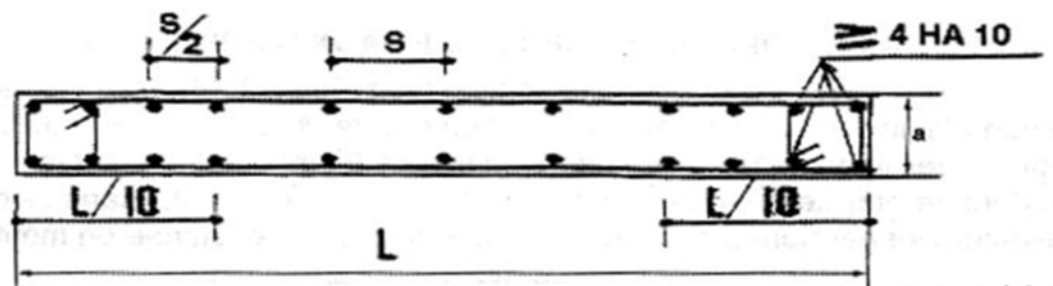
Disposition des armatures verticales dans les voiles
